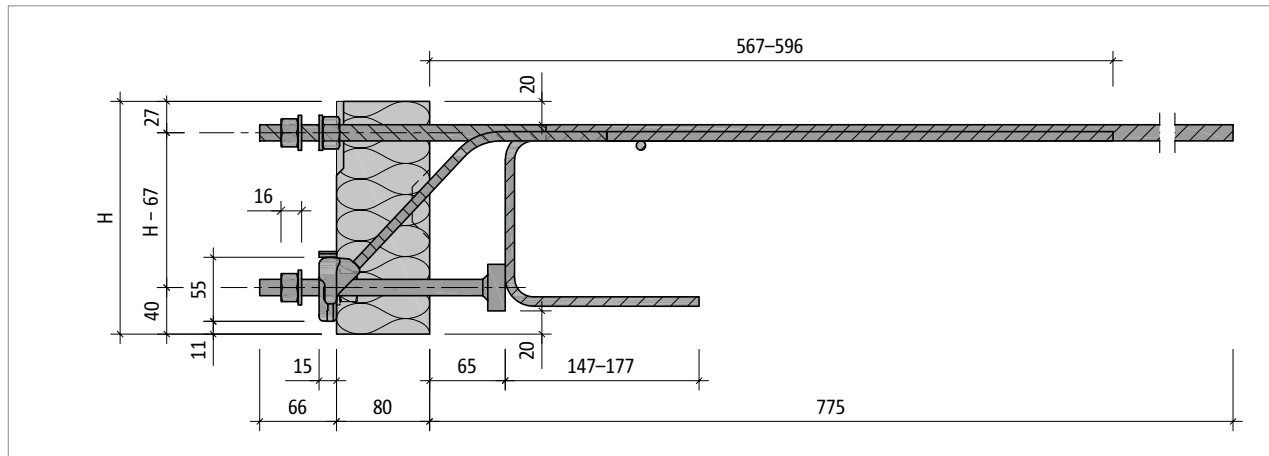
Schöck Isokorf® T type SK-MM2-VV1: Bovenaanzicht
